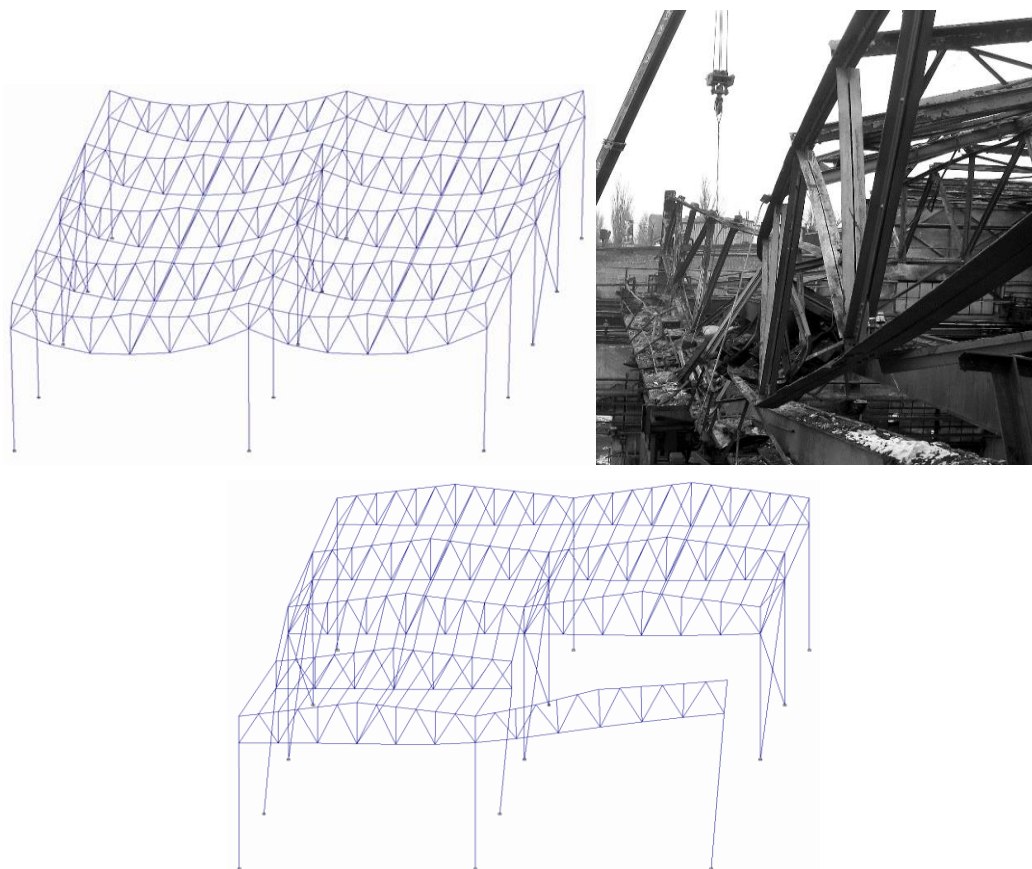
Фрагменти деформованої схеми та вид на покриття одноповерхового сталевого каркаса після локального руйнування колони
